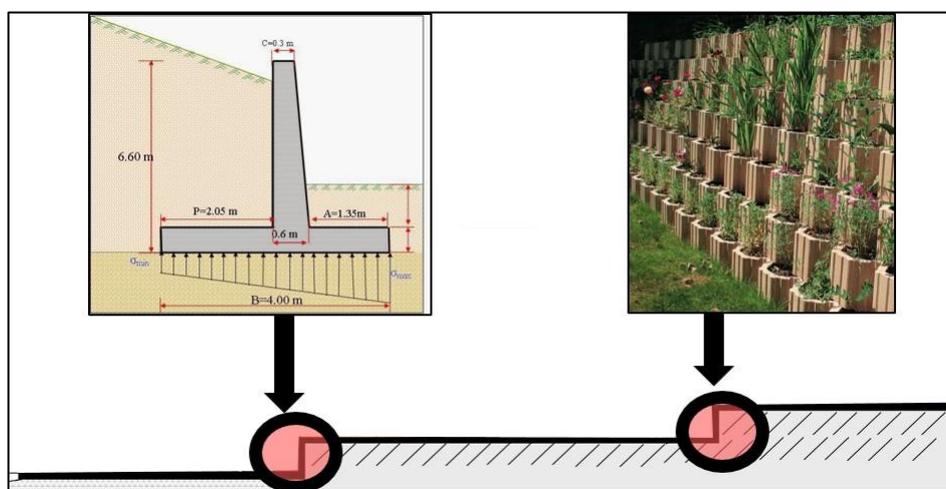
Coupe schématisée sur les plateformes du centre de formation des métiers du bâtiment.
